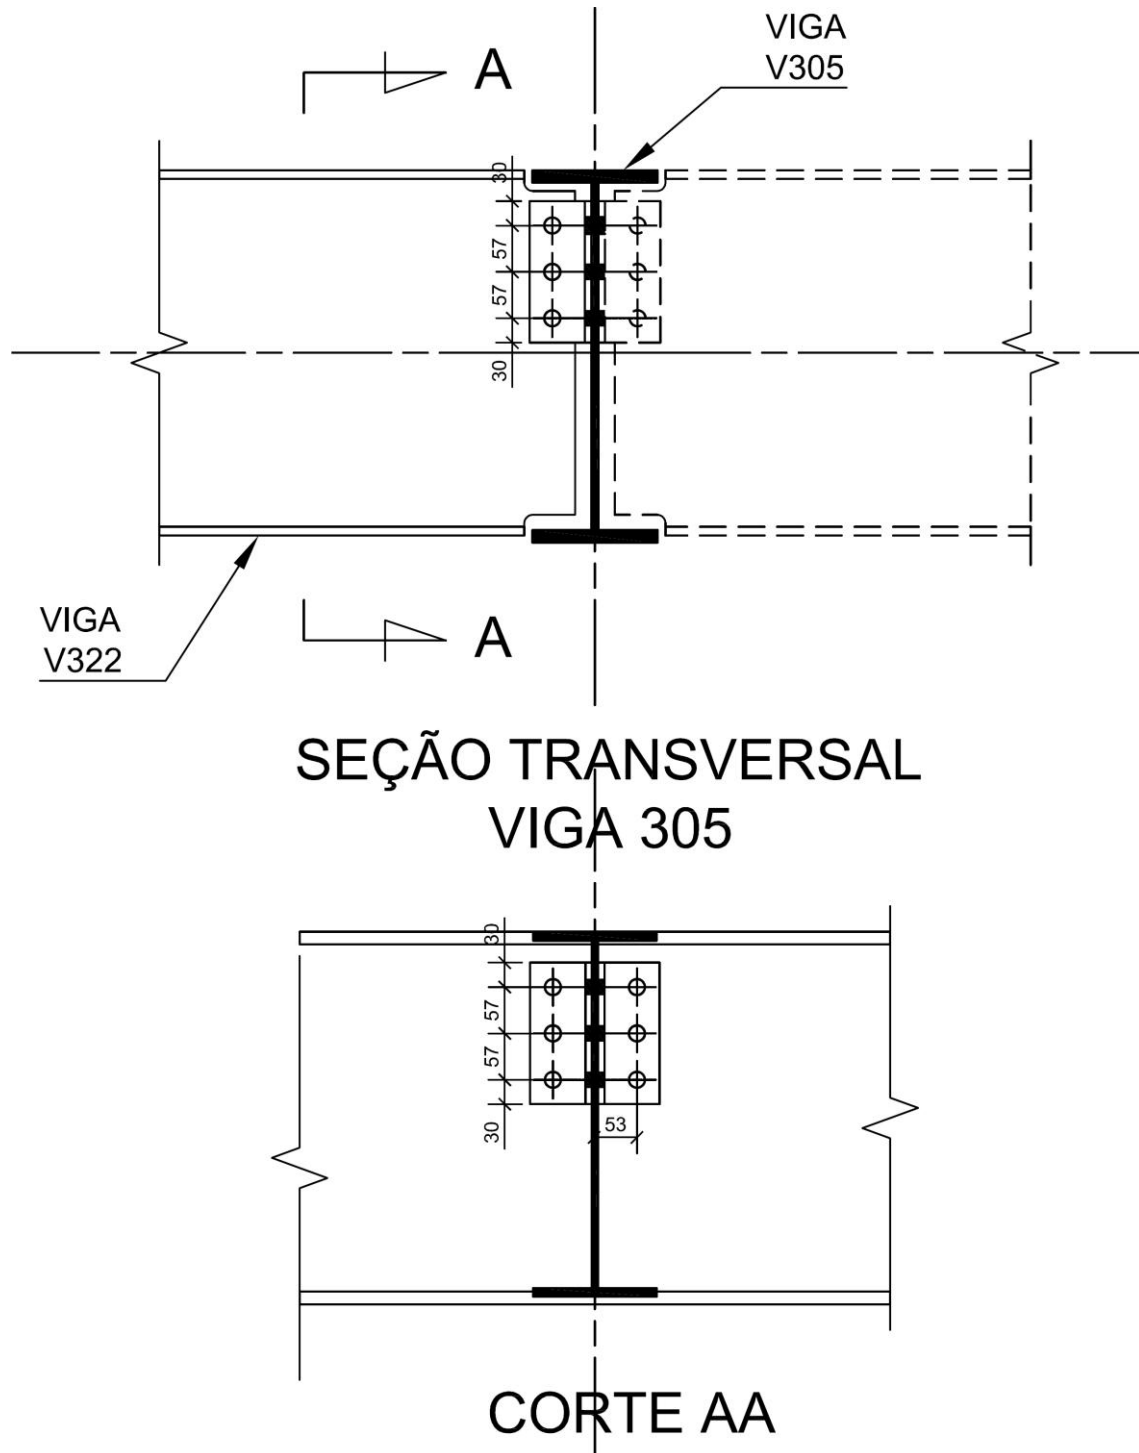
Geometria da ligação viga-coluna (V322 – V305)
